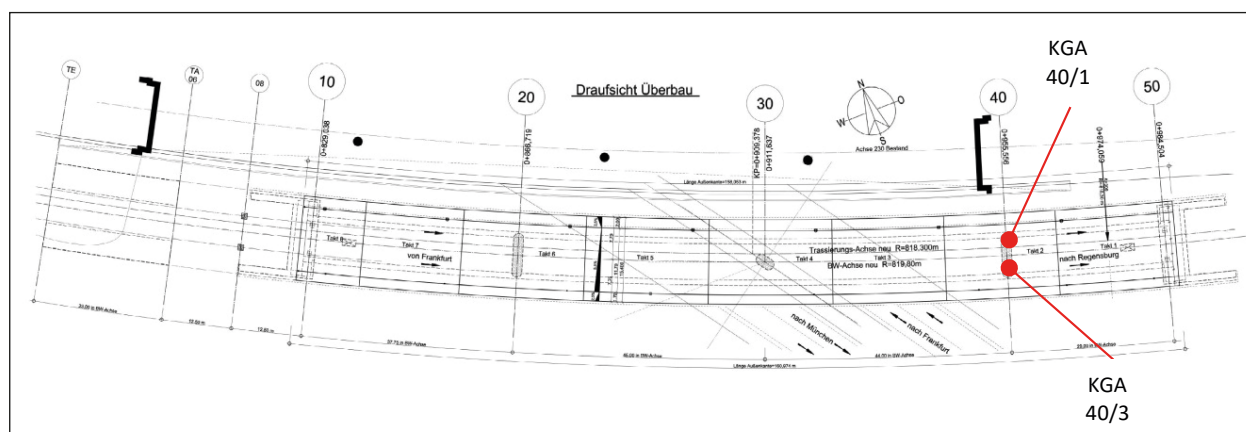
Einbauorte der instrumentierten Lager im BW402e
